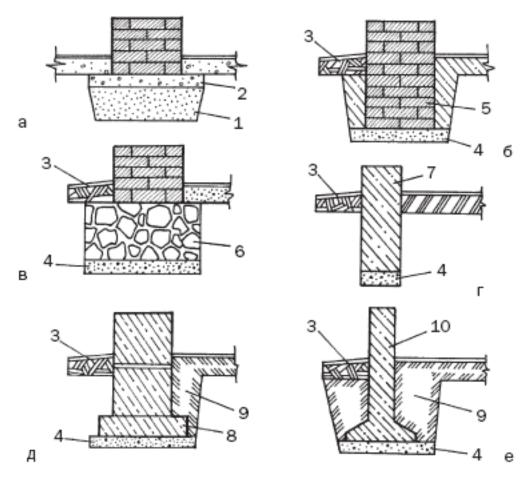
Типы фундаментов: а – песчаный; б – кирпичный; в – бутовый; г – бетонный; д – блочный; е – железобетонный; 1 – крупнозернистый песок; 2 – щебень или гравий; 3 – отмостка; 4 – песчаная подушка; 5 – кирпич; 6 – бутовый камень; 7 – бетон; 8 – бетонный блок; 9 – грунт; 10 – железобетон
